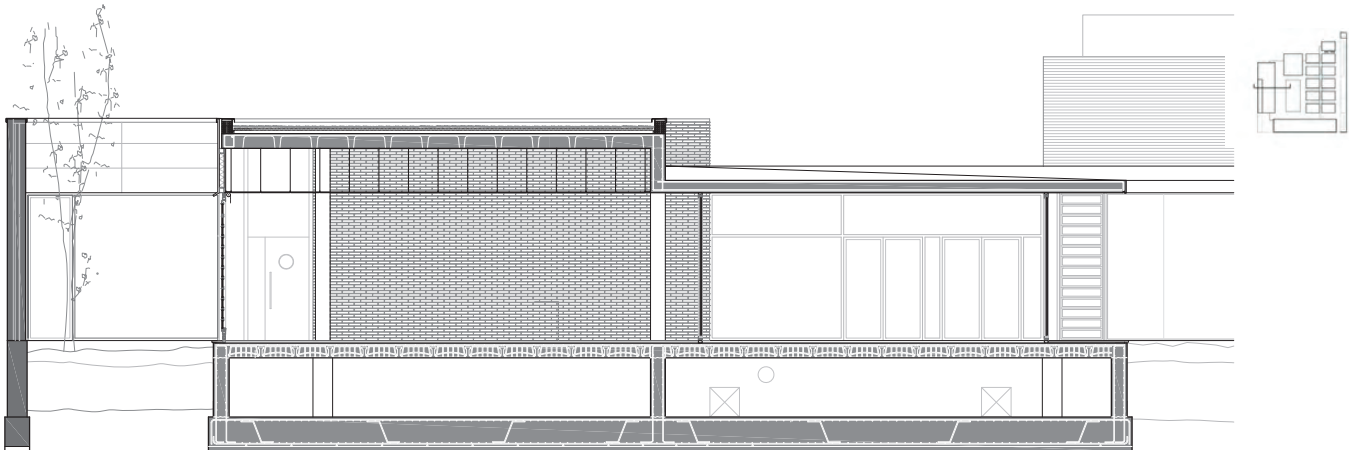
Sección constructiva por el aula de autoaprendizaje (2008) / Figure 5. Constructive section by the self-learning classroom (2008).
